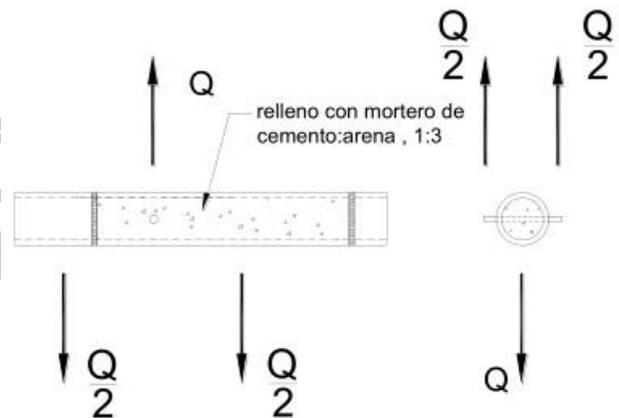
Unión de bambú con cargas a tensión perpendiculares a la fibra, tipo Q
